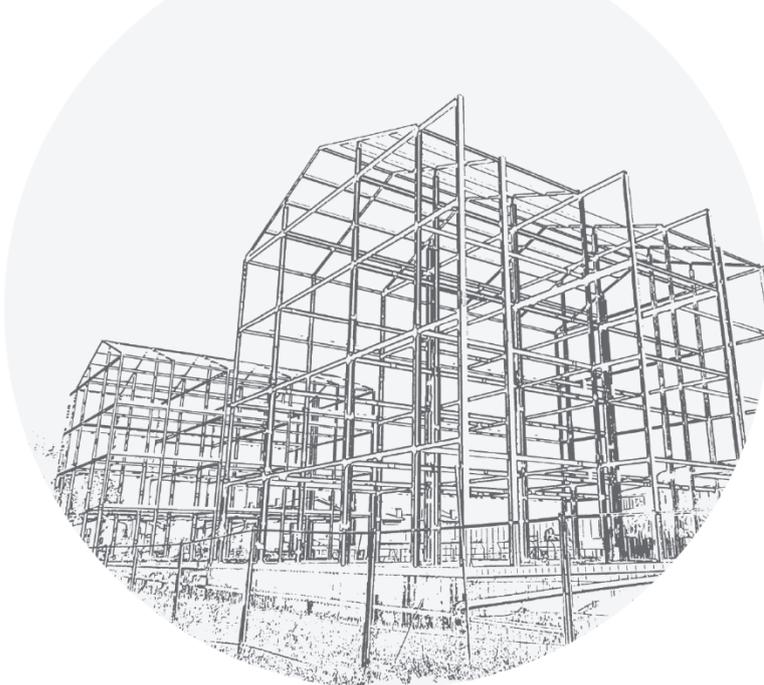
Sovrapposizione dello stato attuale, fotografato a novembre 2021 dall'autrice della tesi, allo stato risalente al 2016, street view della struttura ATER
